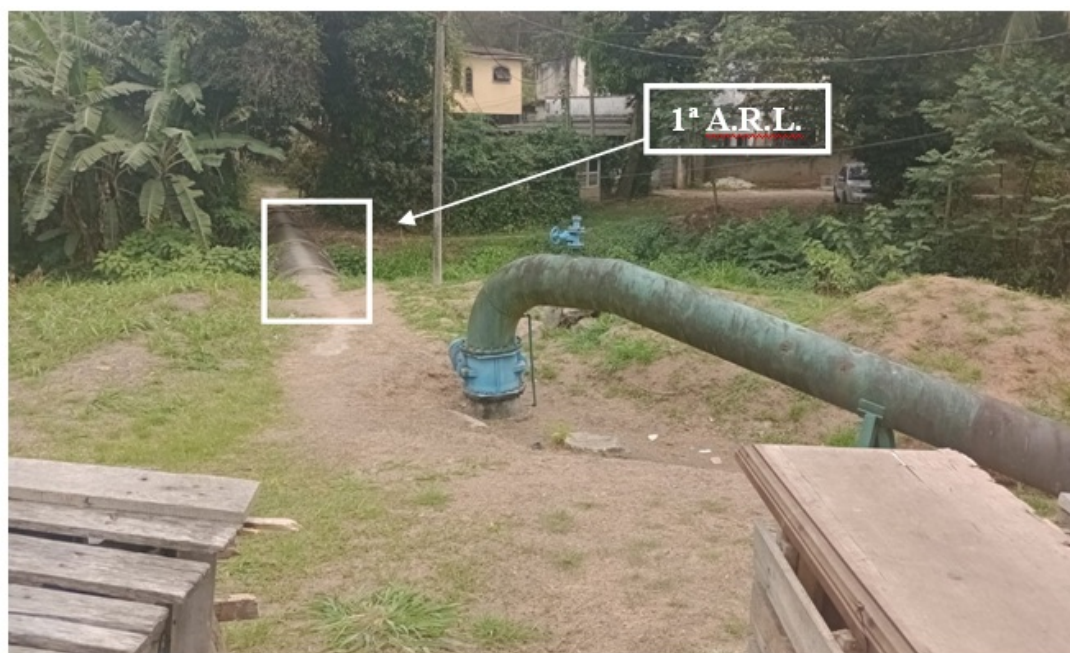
Alça hidráulica (tubulação DN 500 mm) que sai da 1ª Adutora de Ribeirão das Lajes (1ª A.R.L.)
